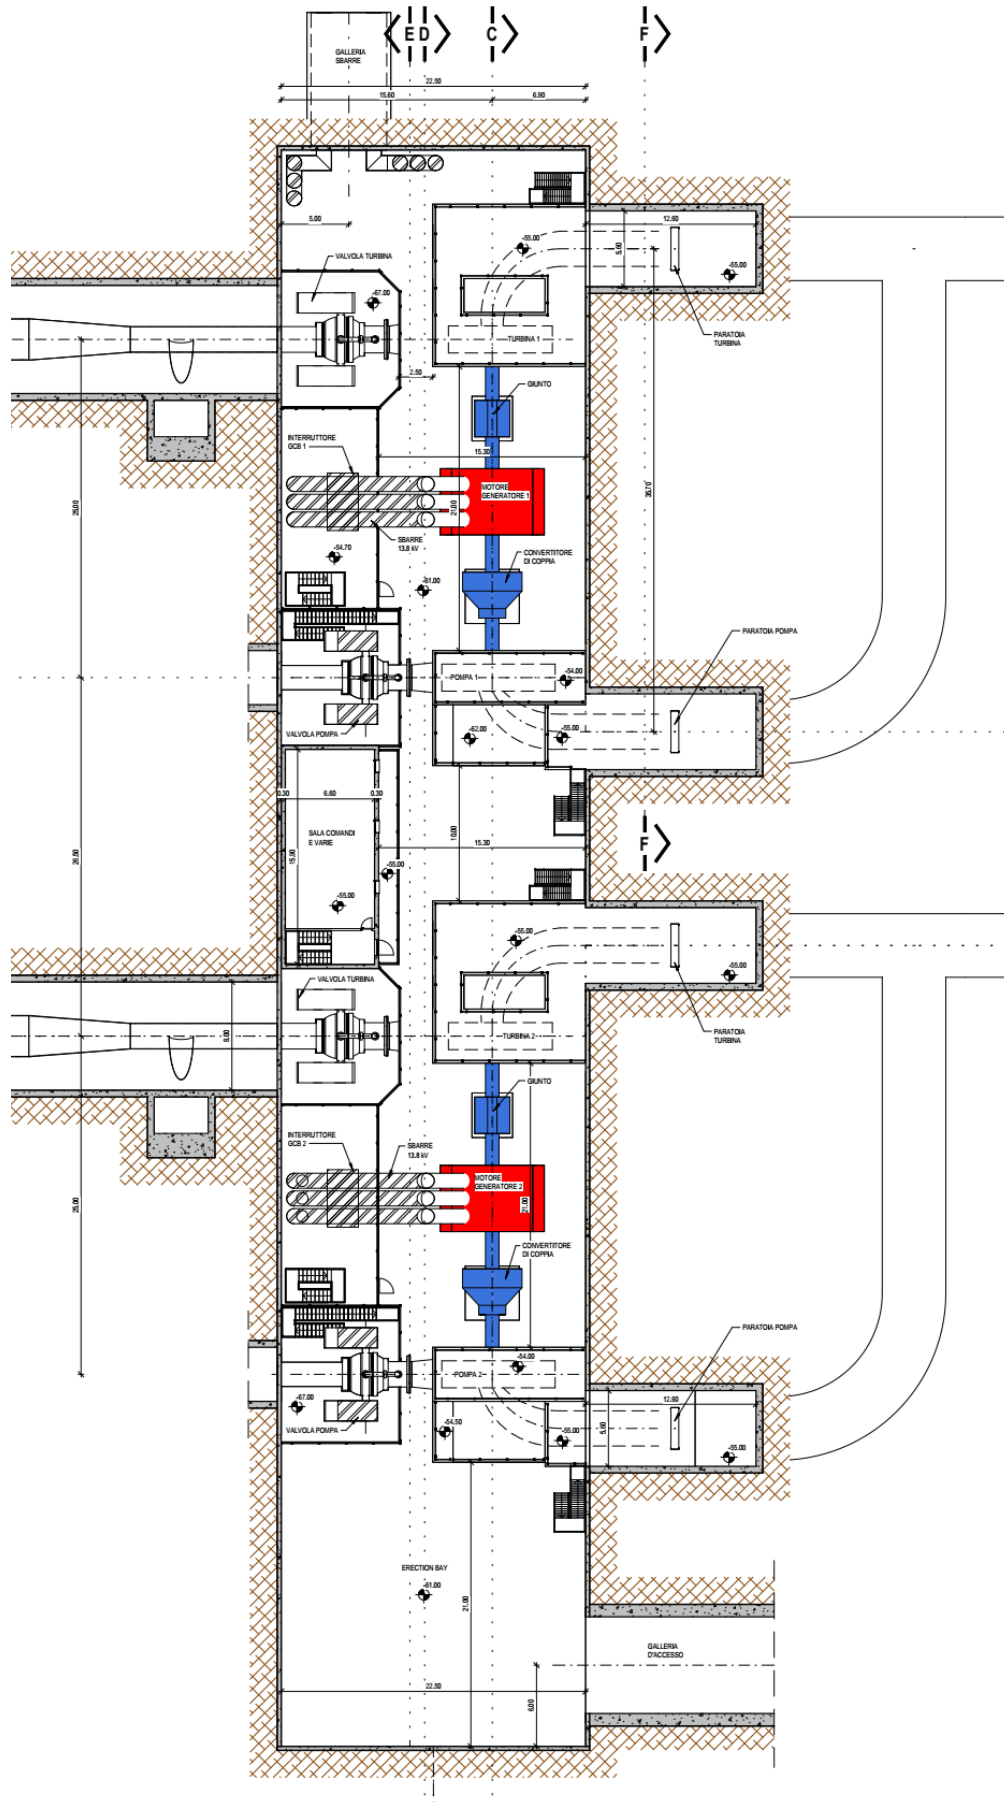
Pianta della centrale – dettaglio della sala macchine
